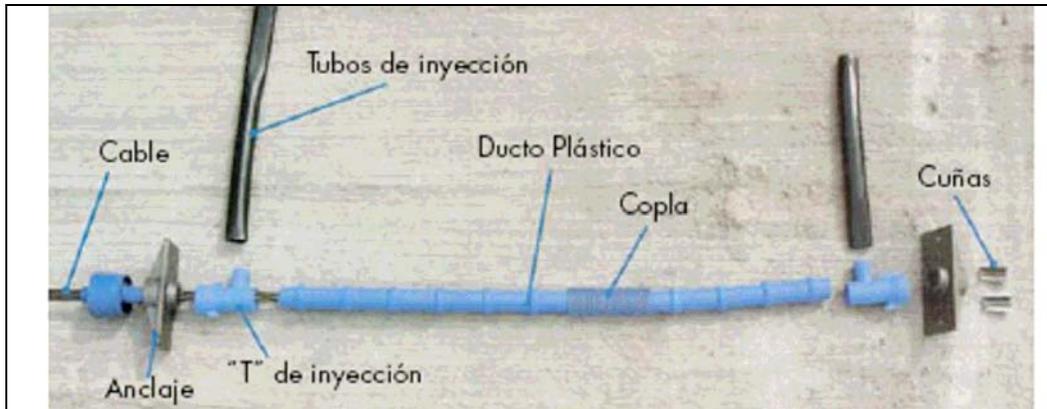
En el sistema de losa postensada con adherencia, sus componentes son ligeros y fáciles de instalar en obra en forma manual, donde las piezas se encajan con una ligera presión.
